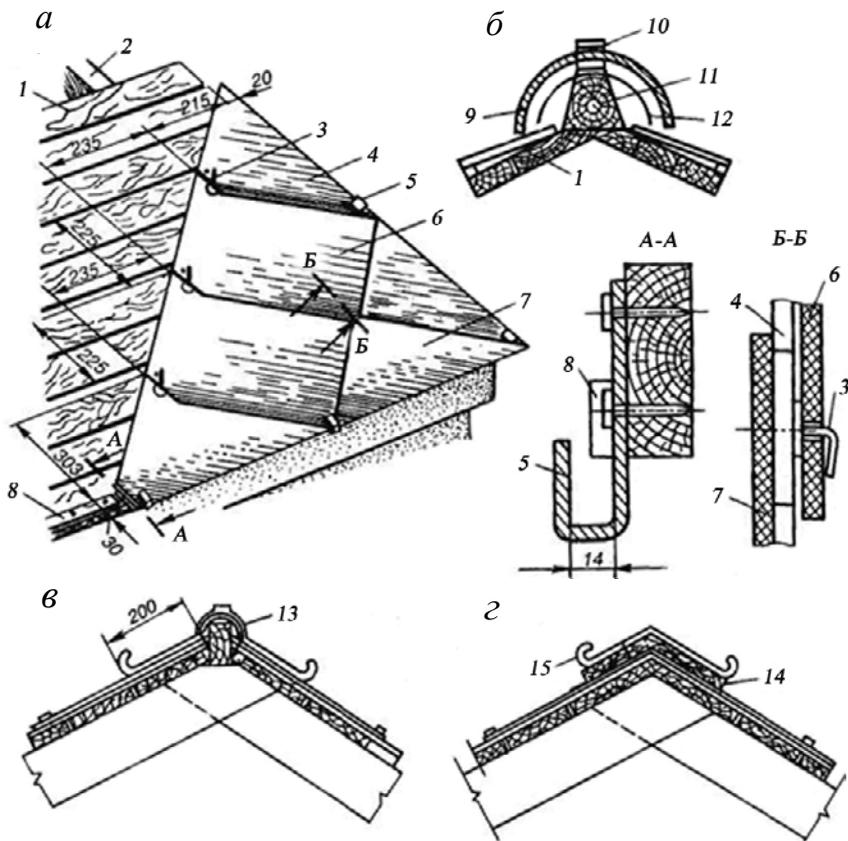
Кровли из асбестоцементных плоских листов:
